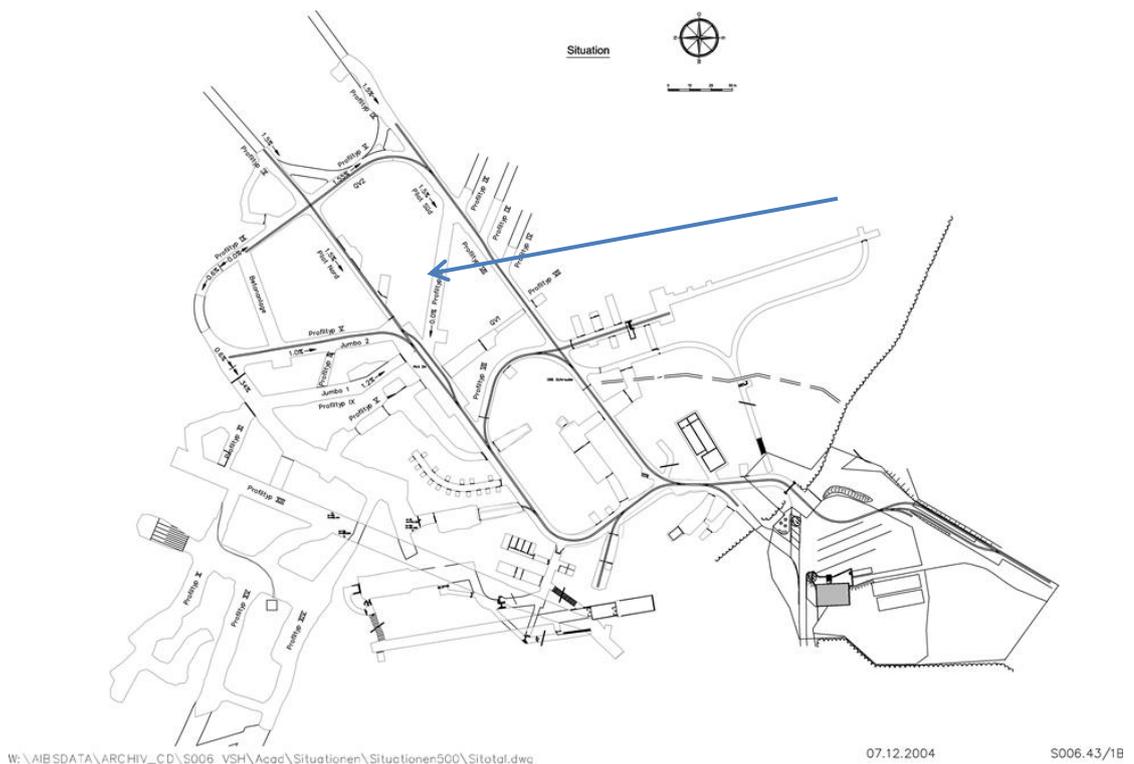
Grundriss VersuchsStollen Hagerbach
